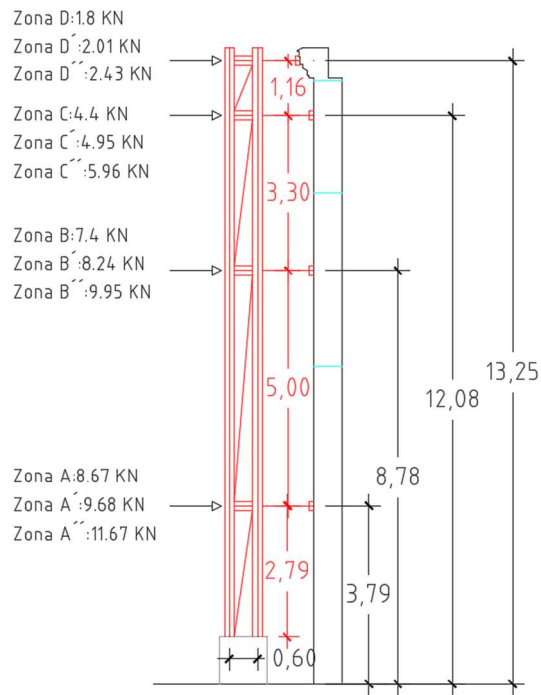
, esquema de la estructura metálica con las fuerzas aplicadas
